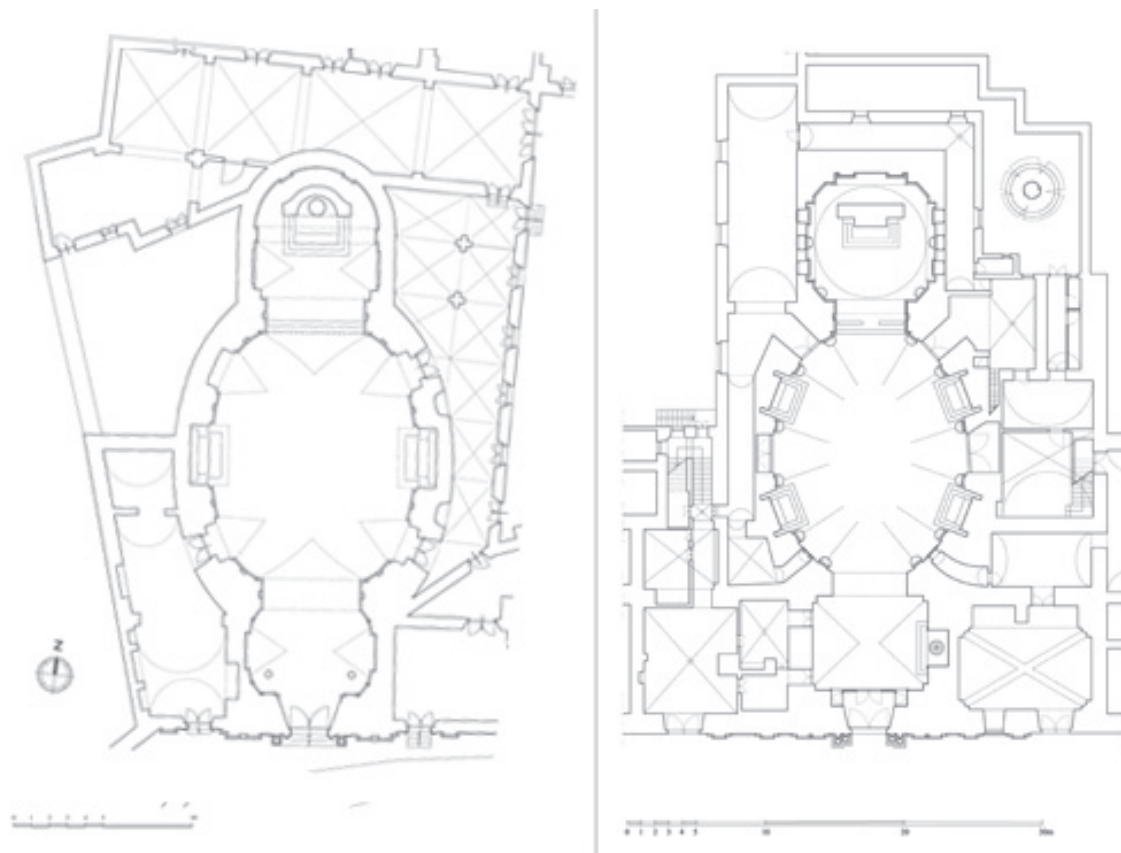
(a sinistra) Pianta della chiesa di Santa Venera ad Acireale (rilievo, da Mauro, 2011); (a destra) Pianta della chiesa di Santa Lucia ad Adrano (rilievo, da Magnano di San Lio, 2010).
